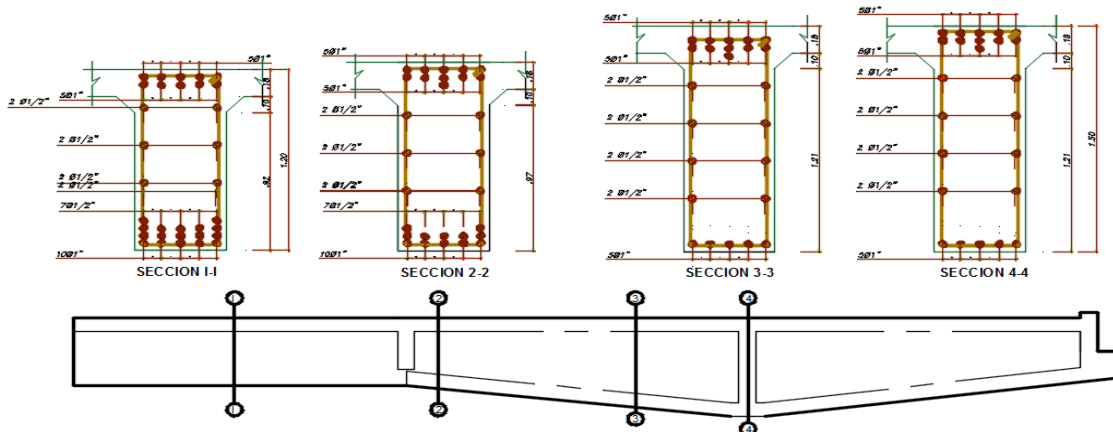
Distribucion de acero en vigas principales adaptado del Plano N°114-8710-11 de E.T para la construccion del Puente Moche
